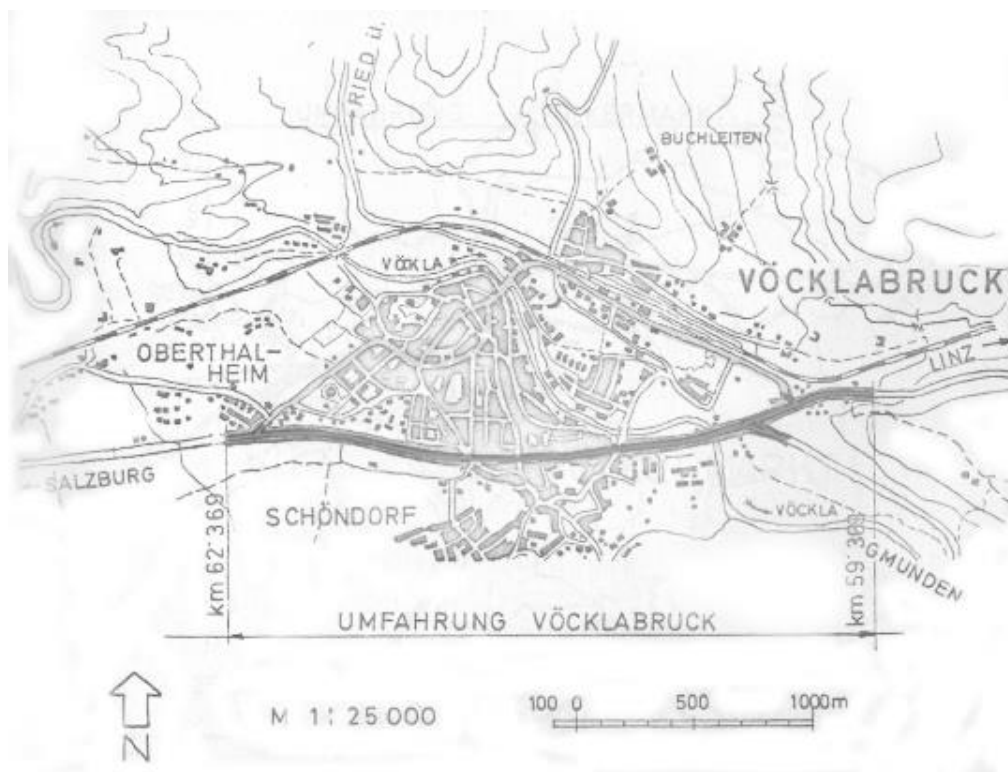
Lageplan um 1960 (Quelle: Dissertation RM)
